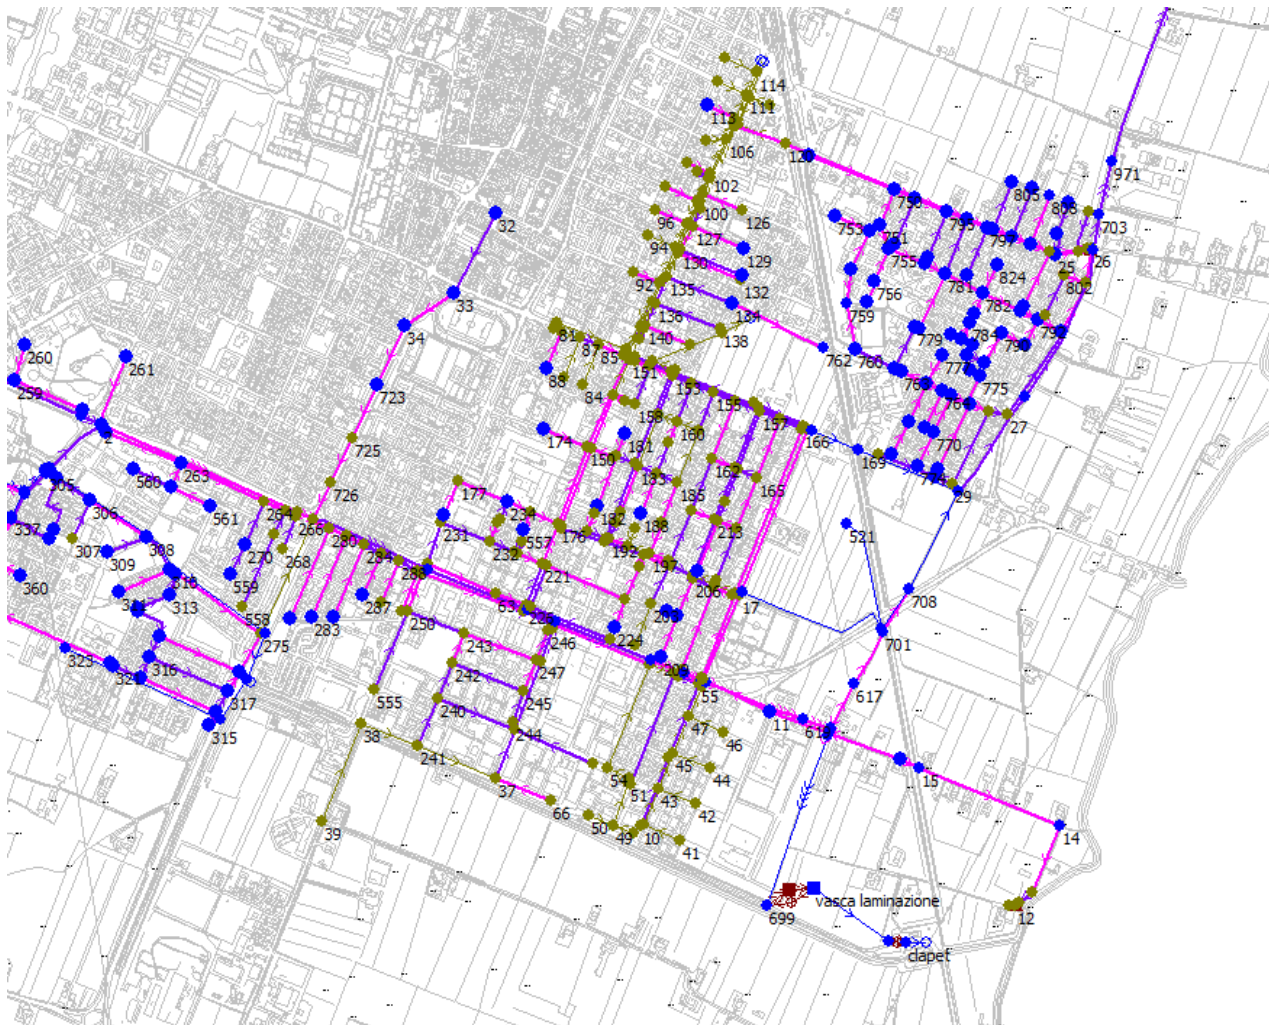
Planimetria delle criticità idrauliche (Stato di progetto)
